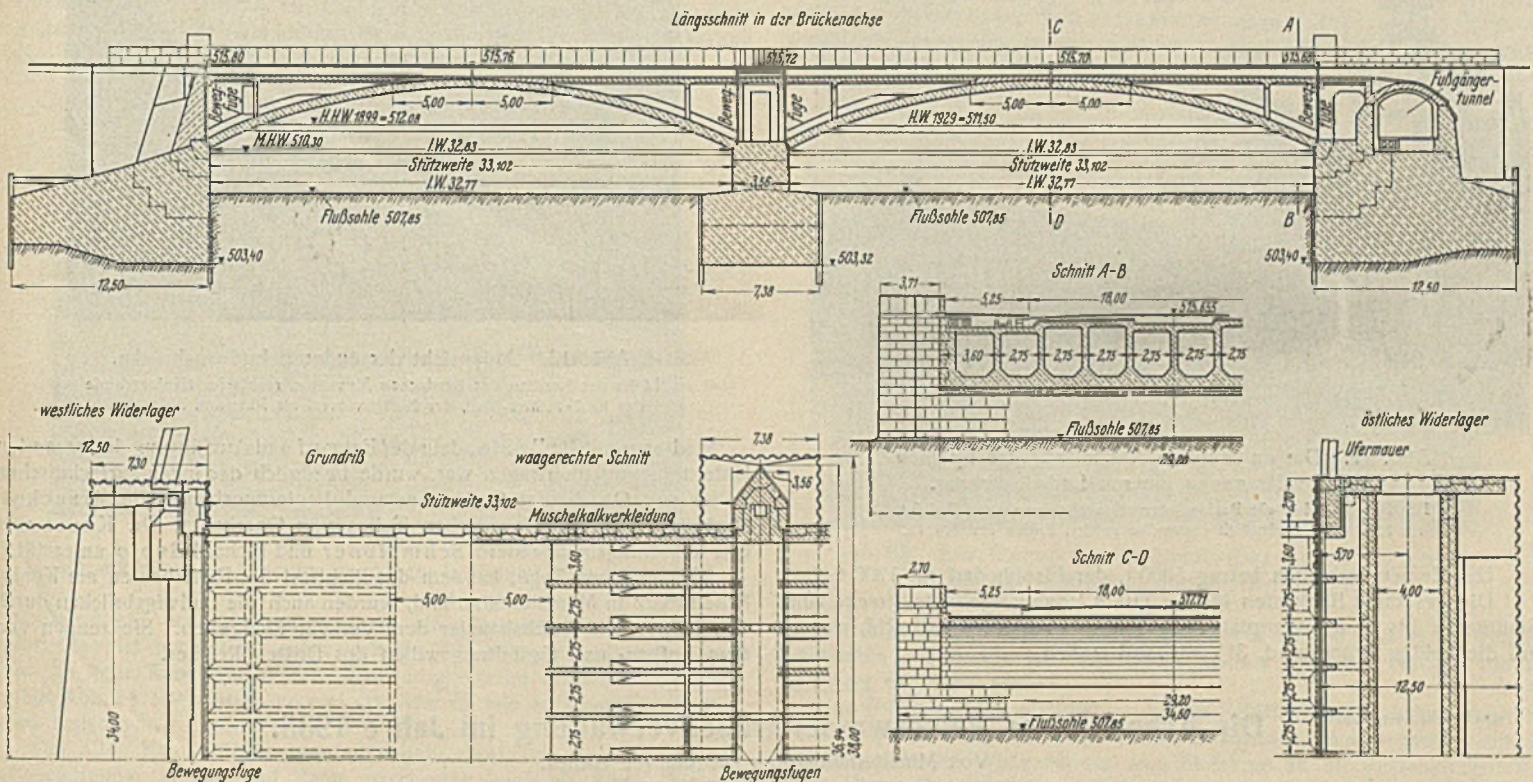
Schnitte und Grundrisse der äußeren Ludwigsbrücke.
